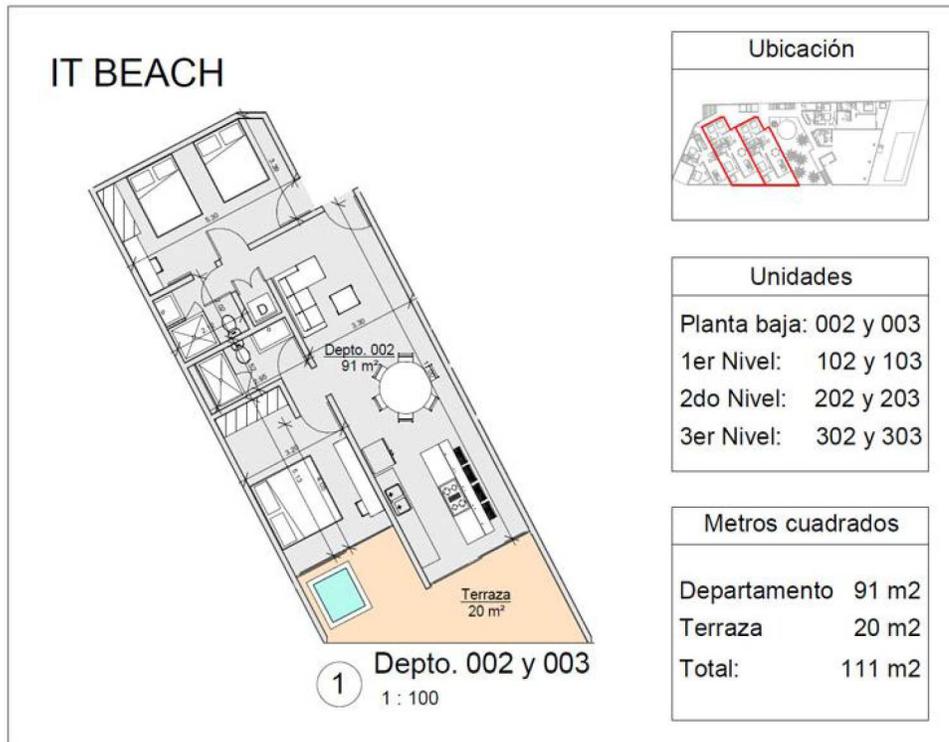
Distribución de los componentes de los departamentos con vista a la Calle Pelicano en planta baja, primer nivel, segundo y tercer nivel.
